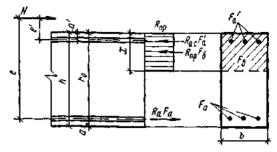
Схема усилий и эпюра напряжений в сечении, нормальном к продольной оси внецентренно-сжатого железобетонного элемента, при расчете его по прочности
